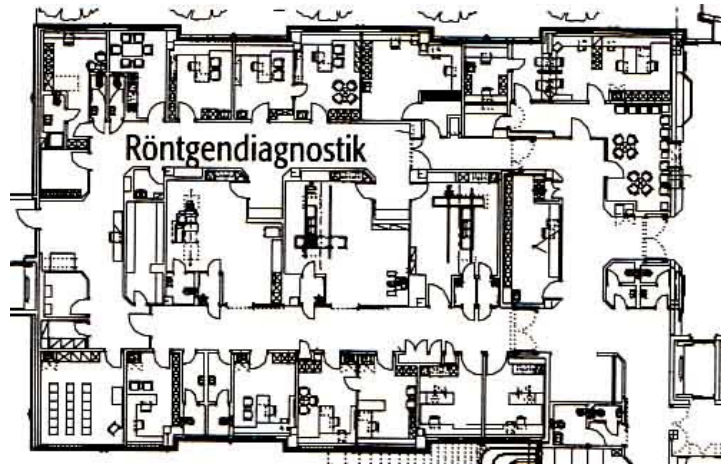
Tek koridorlu plan örneği (Schirmer ve Meuser, 2006, s.164)
